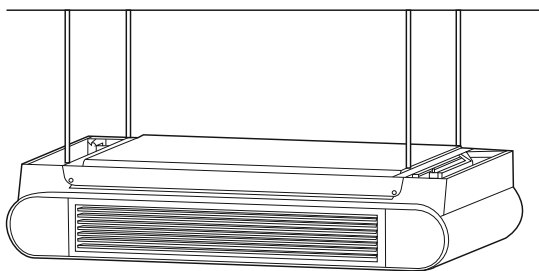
Manera de la instalación de la unidad con cubierta en el techo
